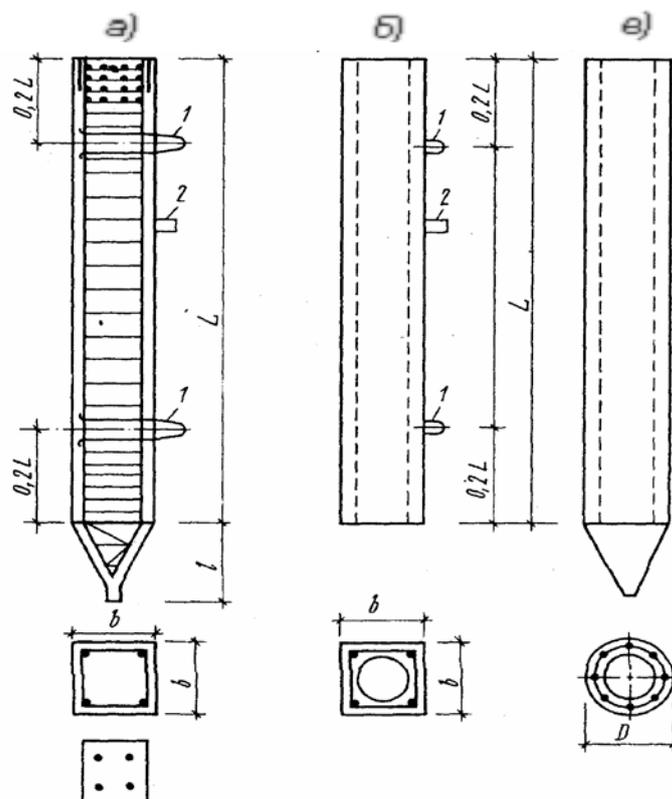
Железобетонные сваи: а – квадратного сплошного сечения; б – квадратного сечения с круглой полостью; в – полового круглого сечения
